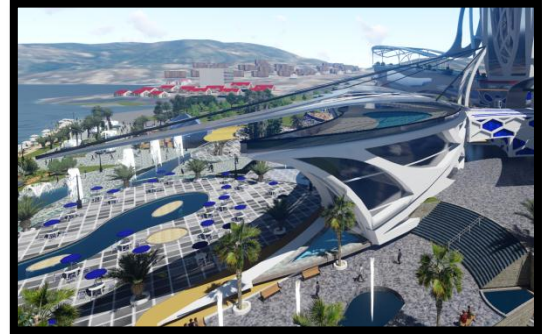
Vue en 3d sur chainage des poteaux poutres de projet .source hauteur de mémoire
